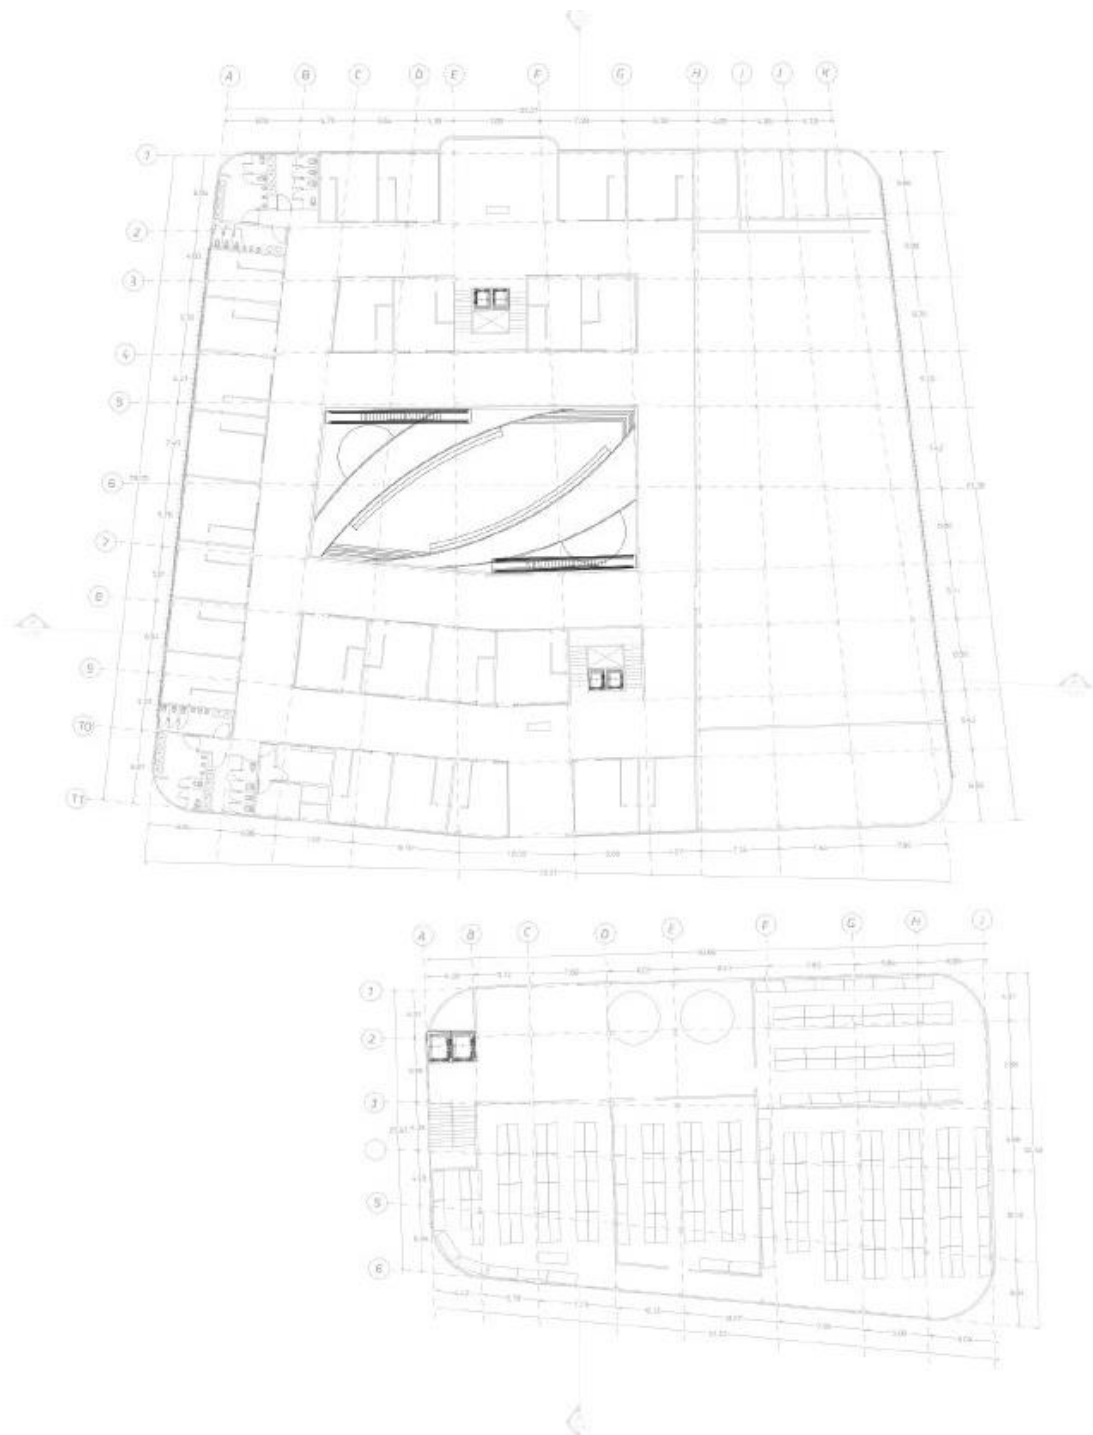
Planta primer piso.Fuente: Elaboración propia.
